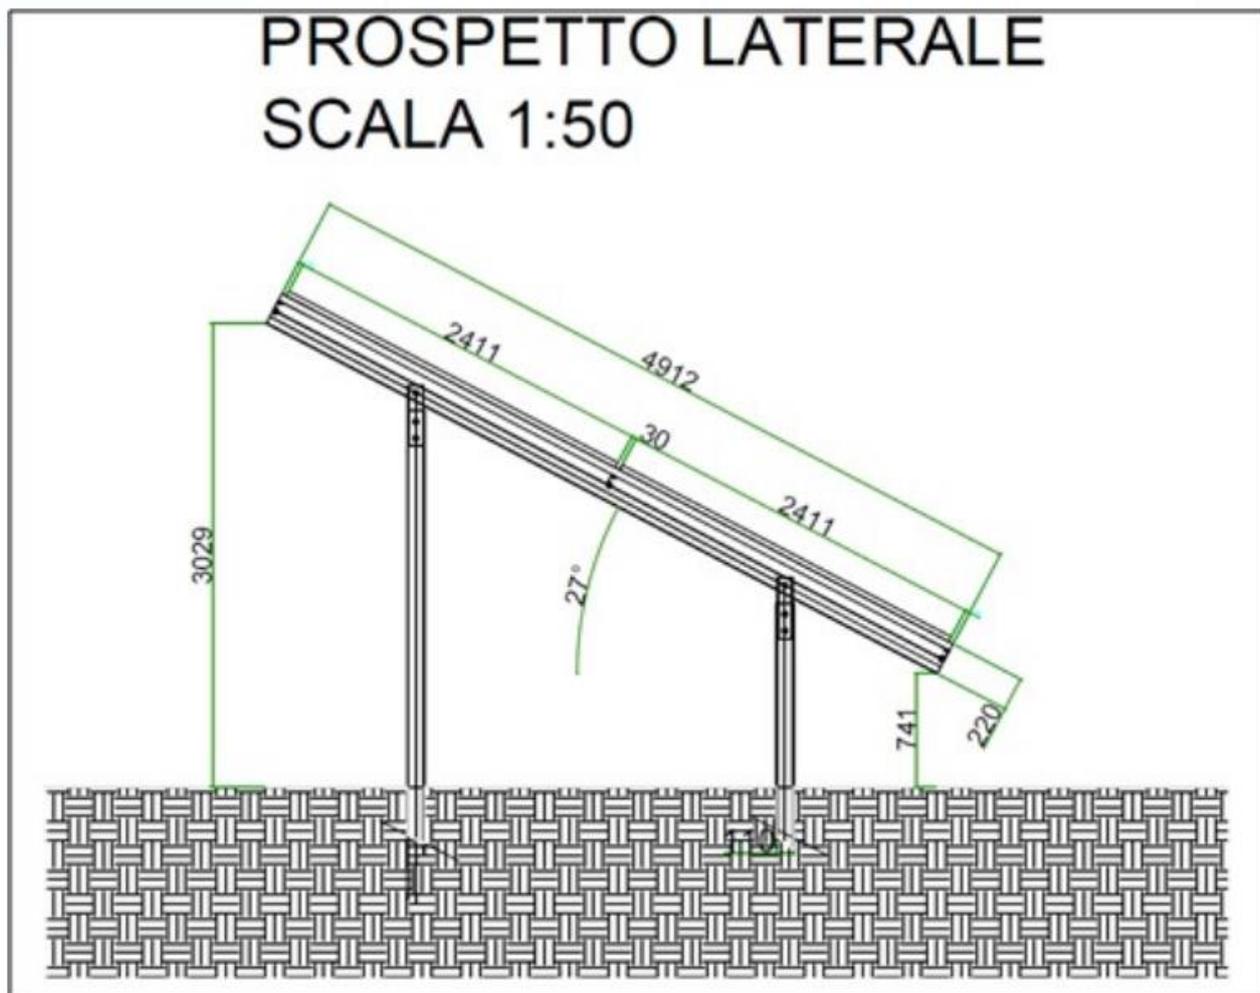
Prospetto laterale delle strutture di supporto dei moduli fotovoltaici
